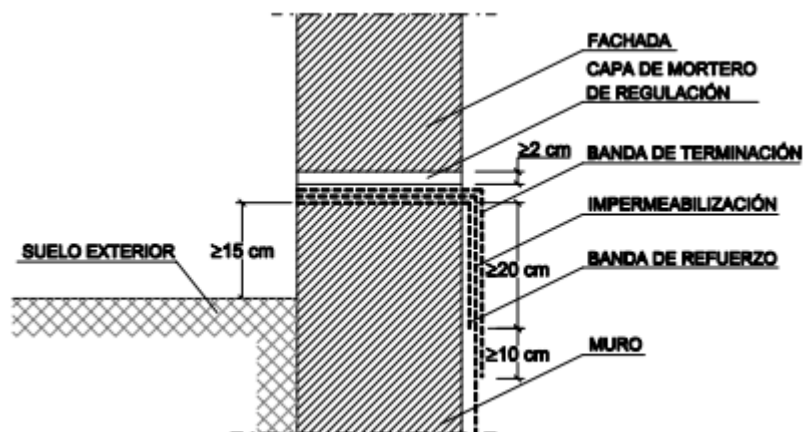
Ejemplo de encuentro de un muro impermeabilizado por el interior con lámina con una fachada.
